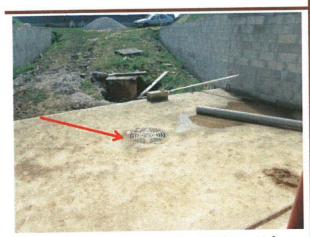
Site de l'effondrement : façade Est de l'habitation
